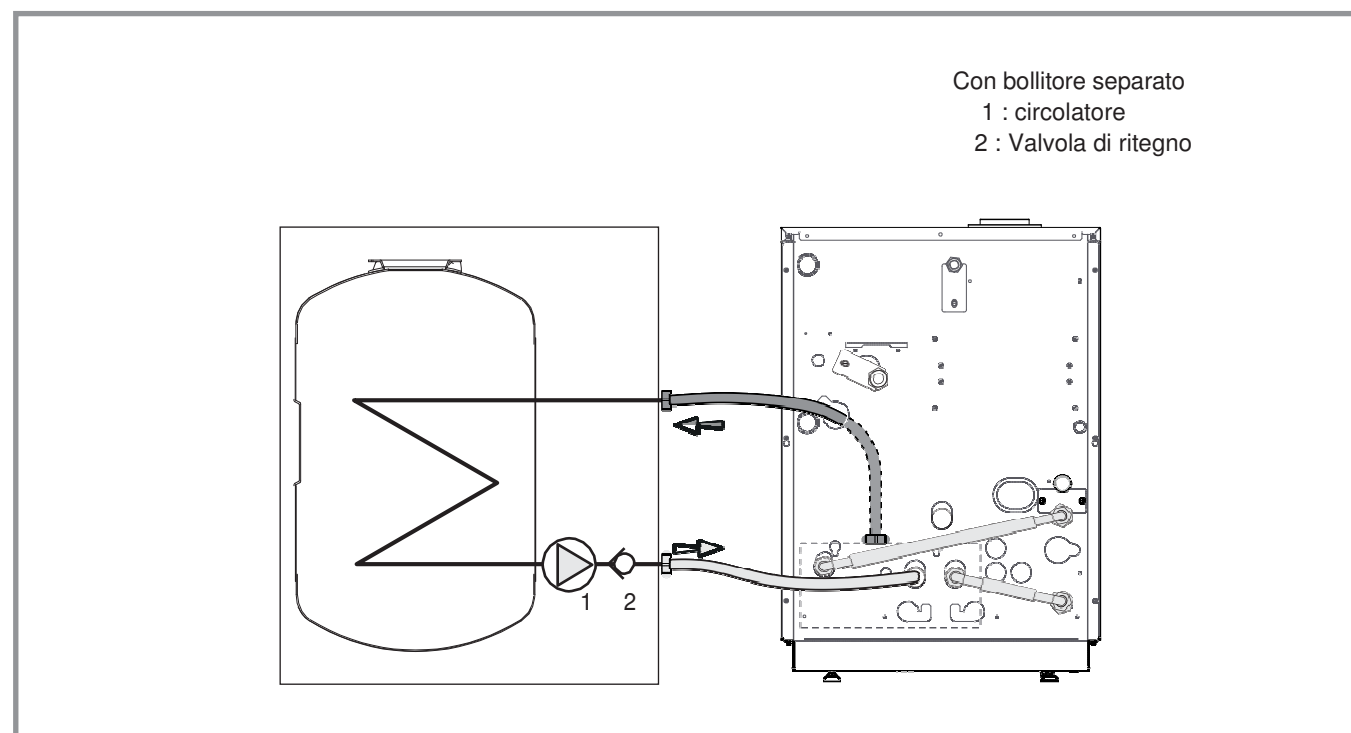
Montaggio flessibili (caldaia solo riscaldamento + ACS)
